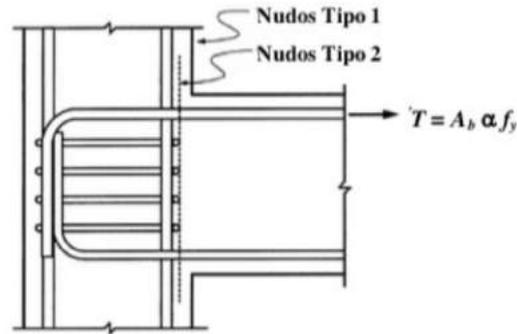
Sección crítica para el desarrollo del refuerzo longitudinal de viga que termina en un nudo
